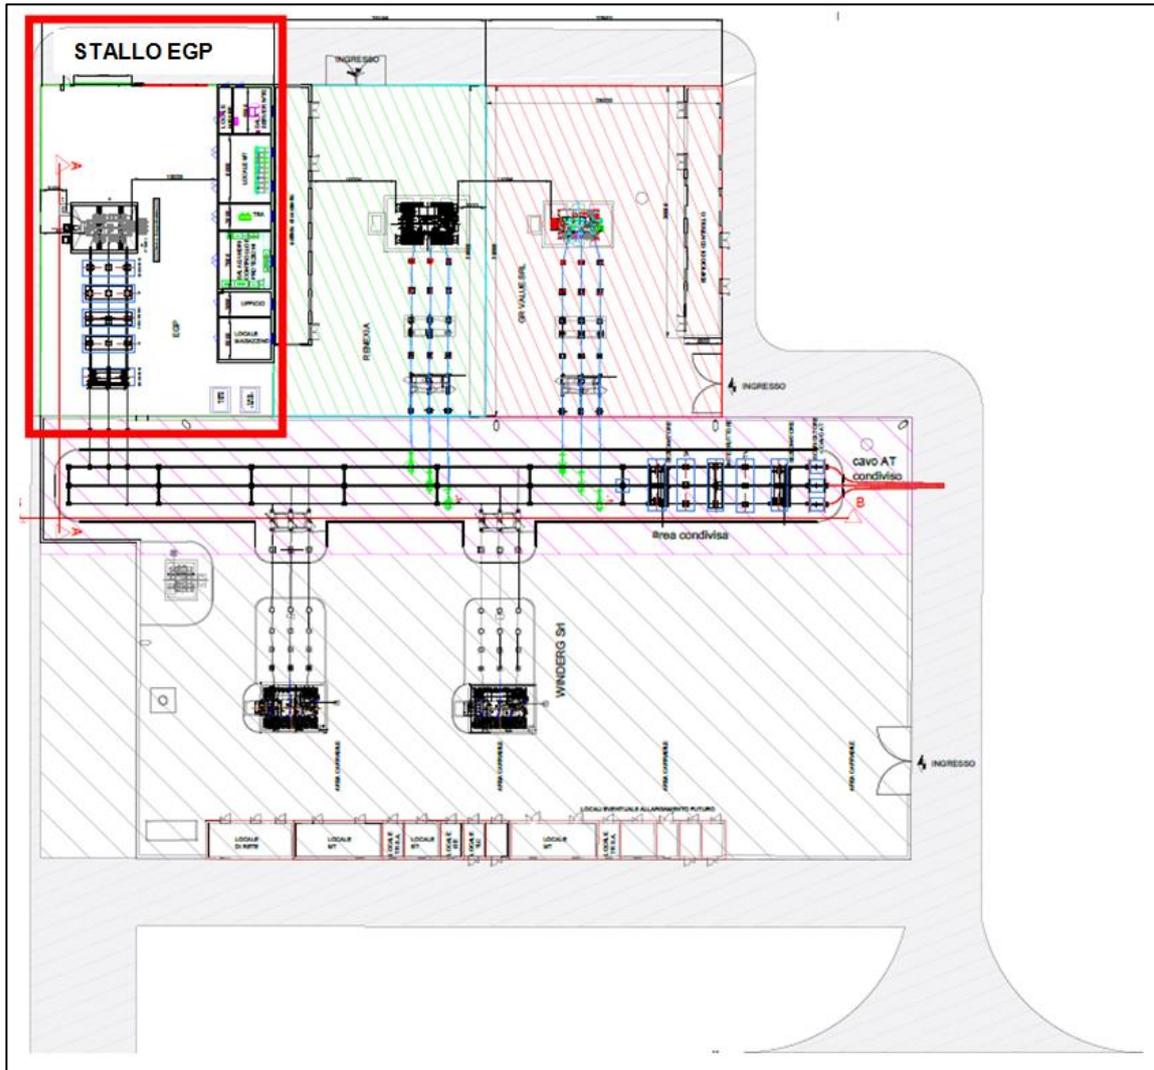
Planimetria elettromeccanica sottostazione MT/AT
